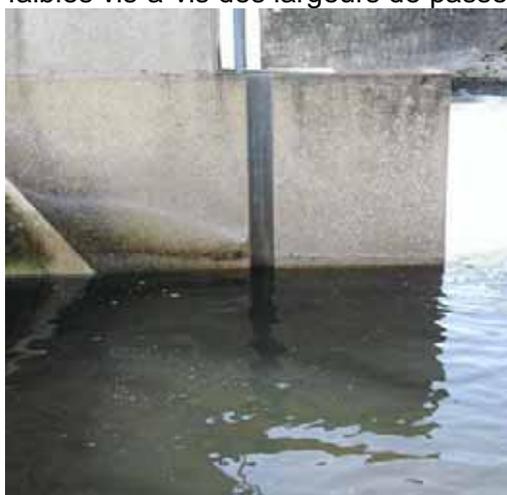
Rainure pour batardeau à poutrelles (barrage de Vermont)
